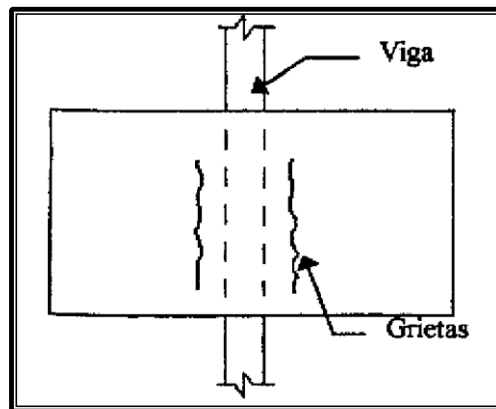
Fisuras en la parte superior de la losa cerca de la viga de apoyo y paralelas a este (Falla por momento negativo en losas continuas)
